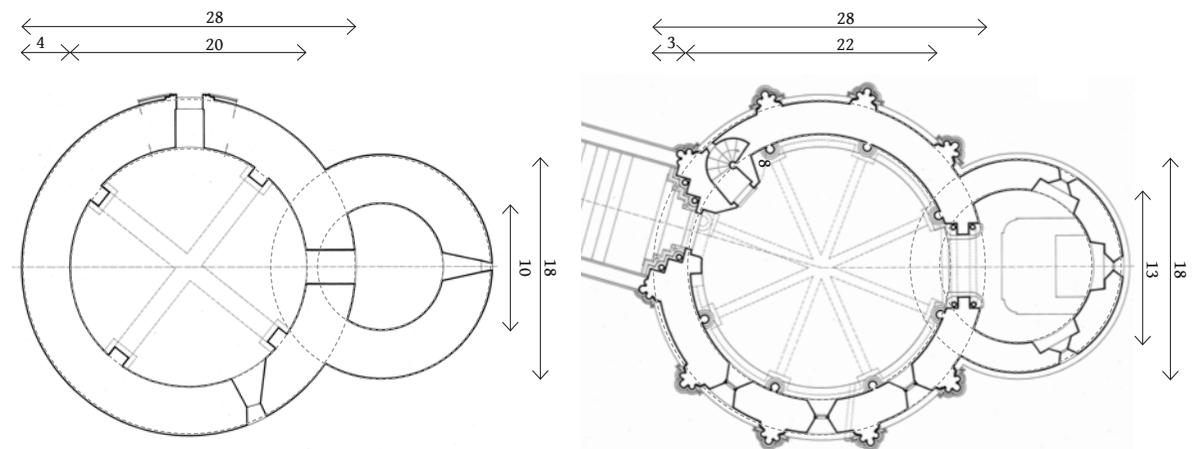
Grundrisse mit den kodierten Hauptmaßen in Fuß. CA 2016.
